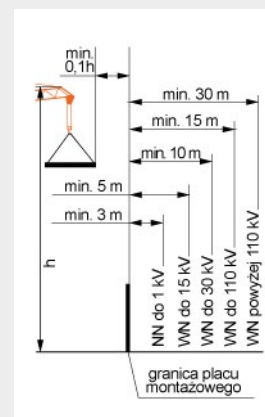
Strefa niebezpieczna przy montażu konstrukcji stalowych
